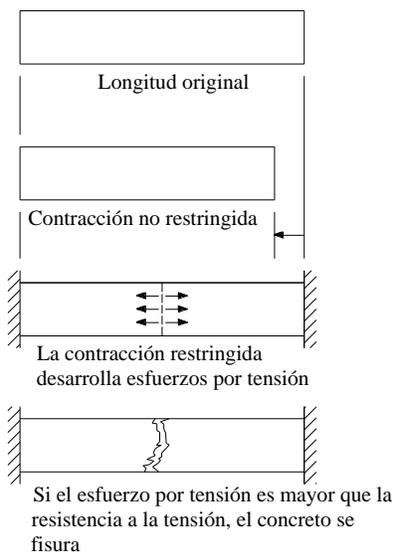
Fisuración del concreto debido a la contracción por secado
